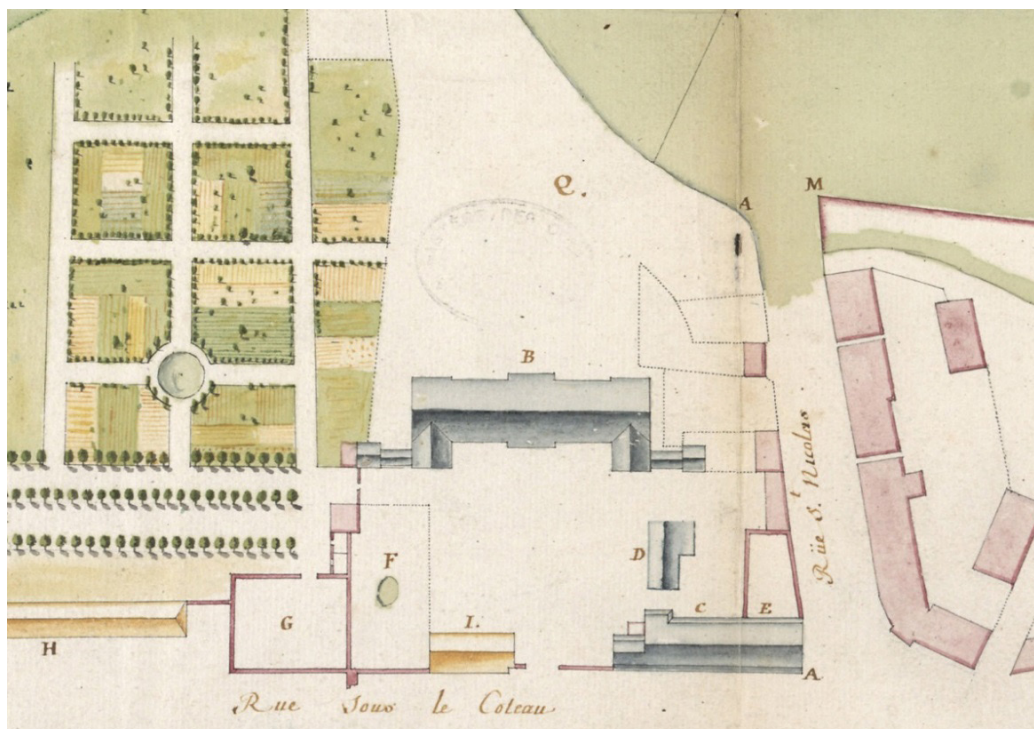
Plan de 1739, le « F » représentant la basse-cour par Chaussegros de Léry.
